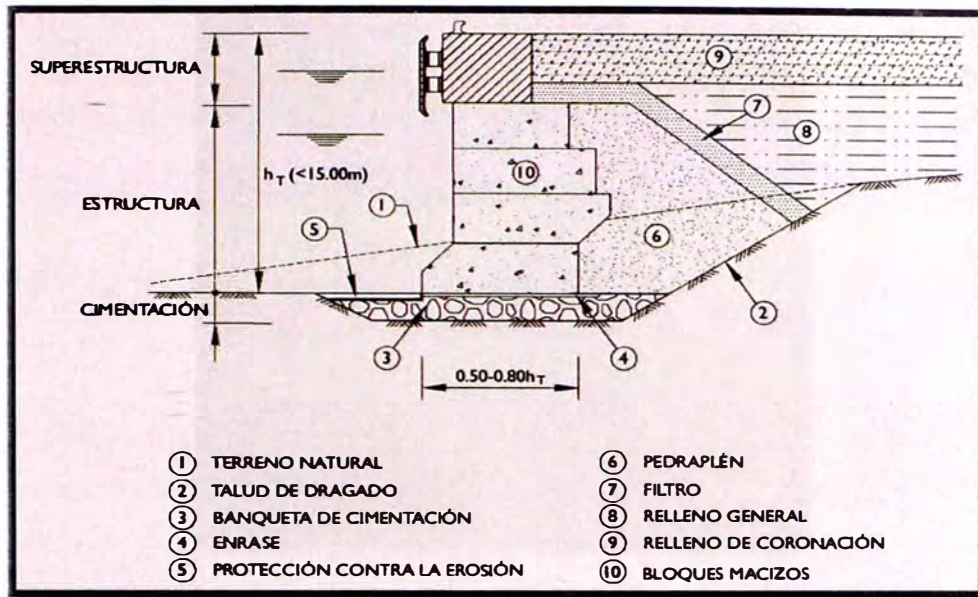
Sección Tipo de Muro de Gravedad de Bloques
